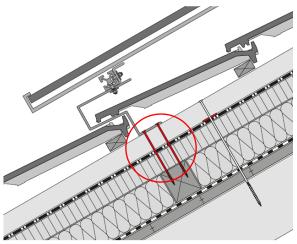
Die Schrauben der Dachhaken durchdringen das Unterdach. Diese Durchdringungen müssen mit Nagelbändern/Nageldichtungen abgedichtet werden.
